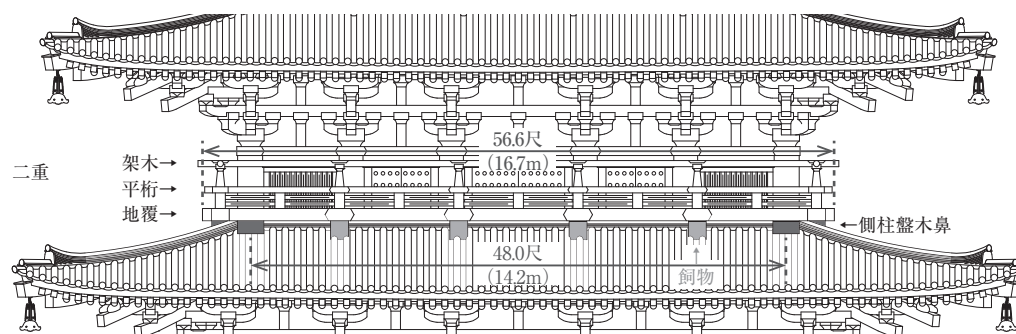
天平塔 二重の高欄と支持方法 (二重高欄立面図) 1:200
